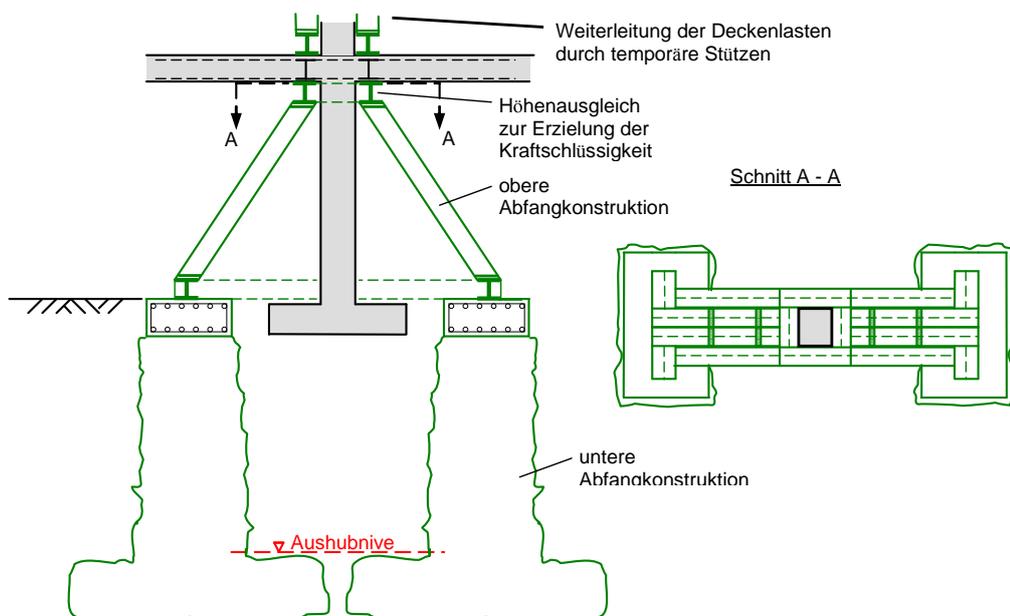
Konstruktives und Baubetriebliches System (Variante II):
